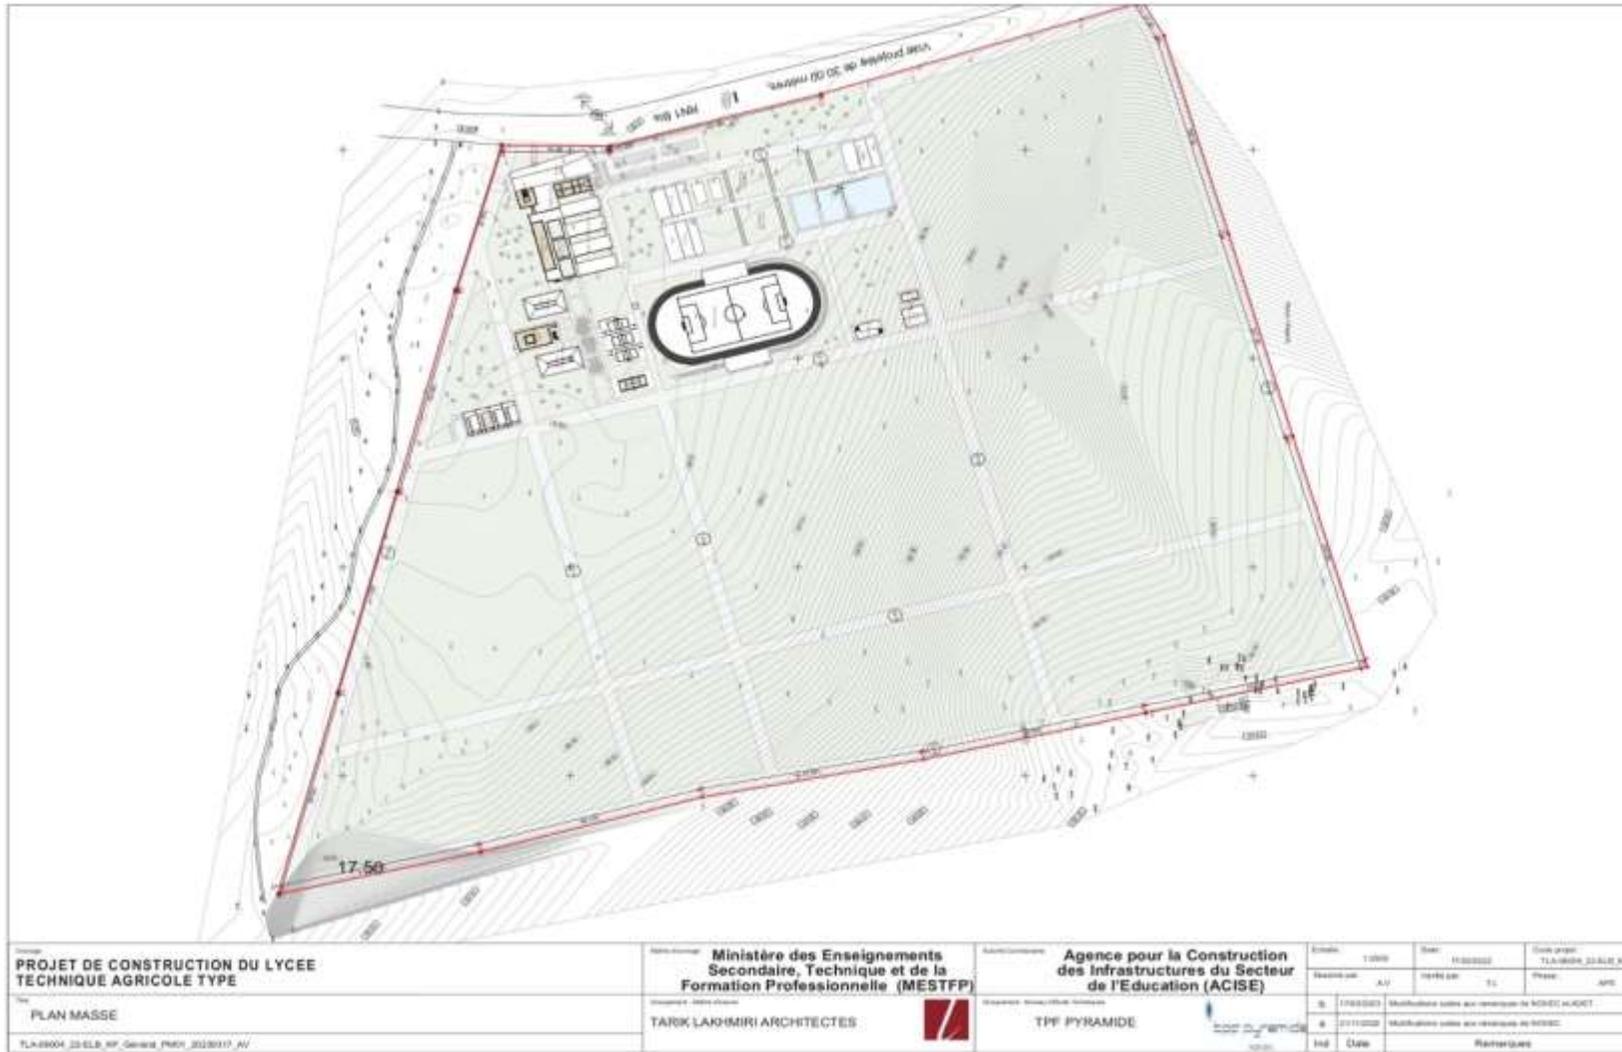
Plan de masse type de construction du Lycée Technique Agricole
